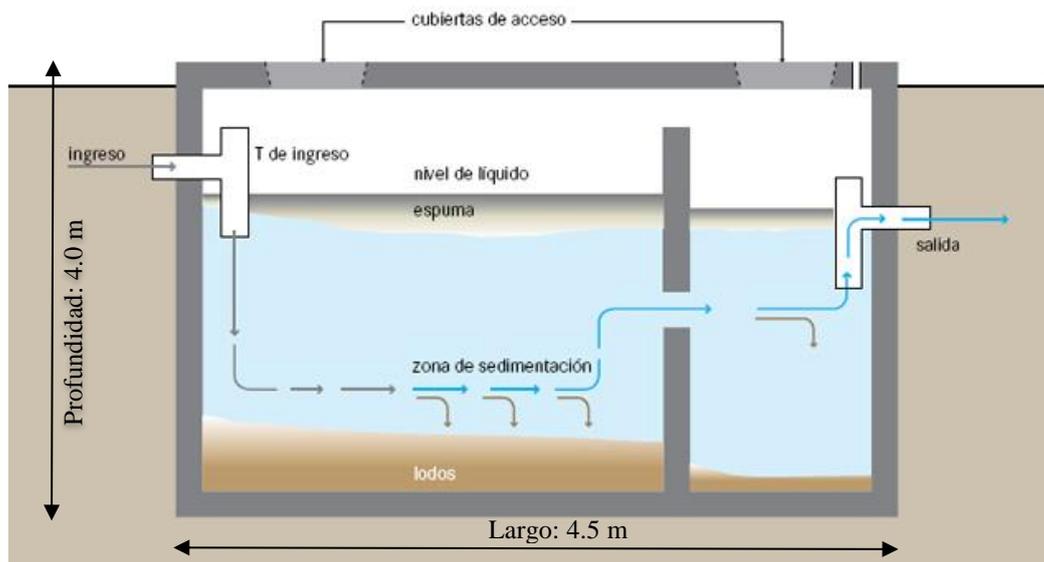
Dimensiones del tanque Imhoff. Fuente propia.
